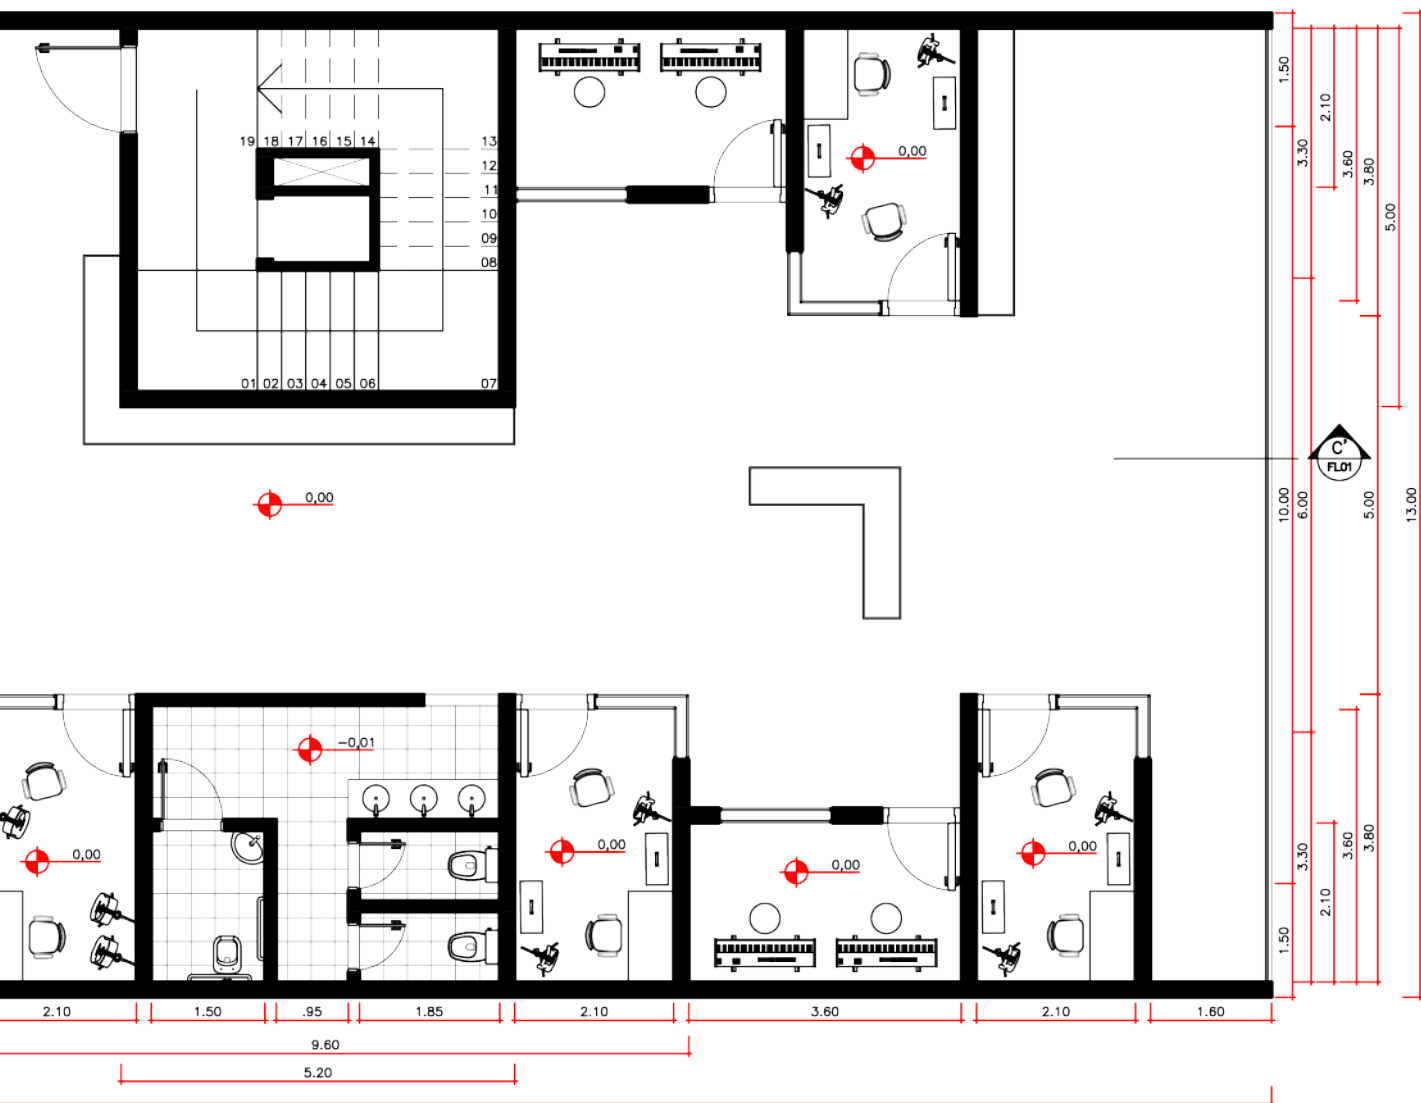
BLOCO SALAS DE AULA - PLANTA 0 - ESC.: 1:100
